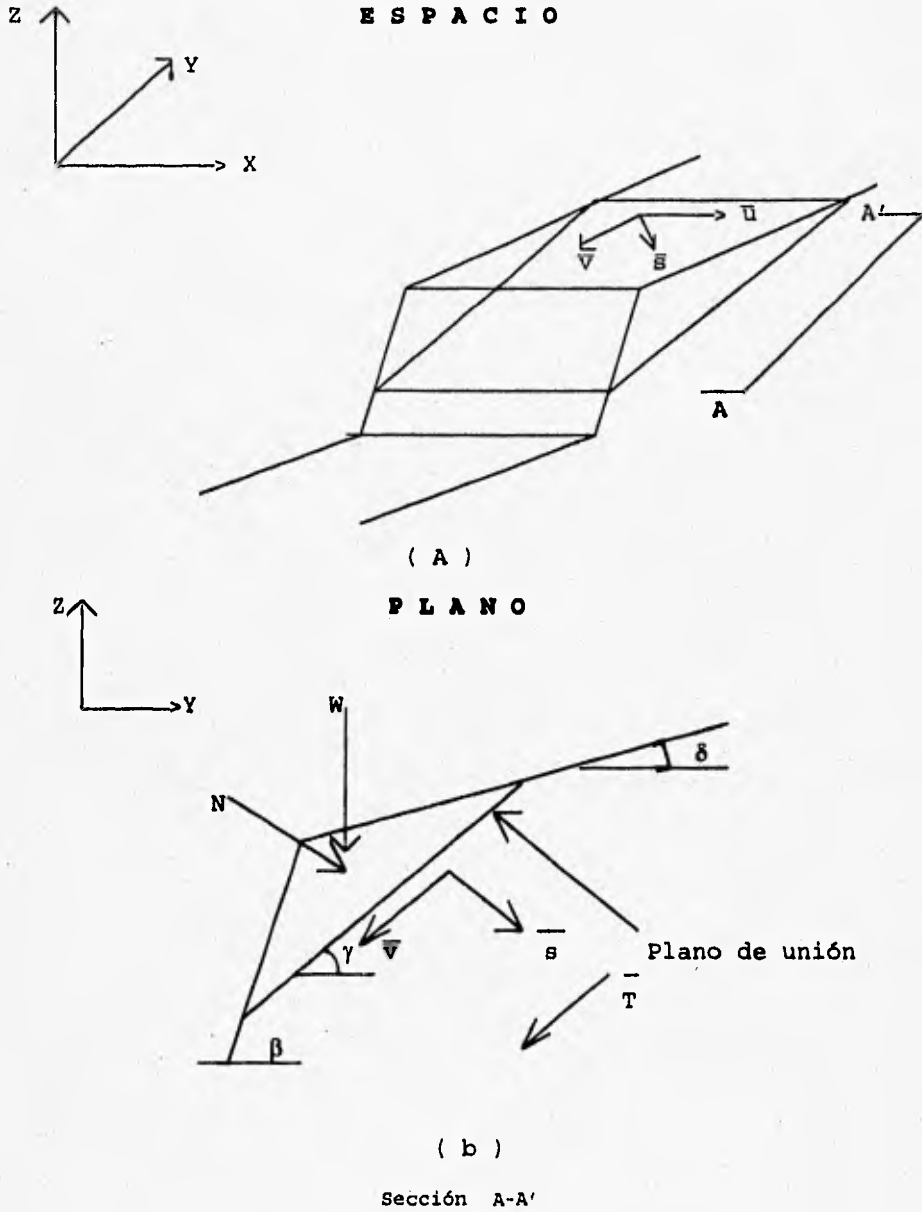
DESLIZAMIENTO EN UN PLANO - RUMBO DE UN PLANO
